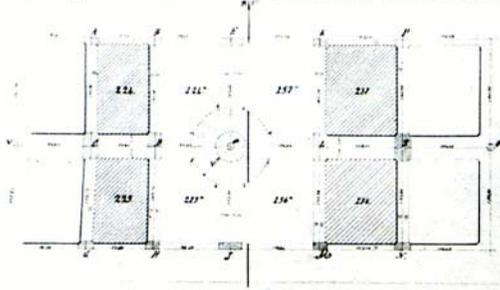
La organización espacial de Salamanca. Alternancia tiendas-viviendas en la planta baja (1869). El croquis no está a escala. Fuente: AHP, protocolo n.º 27.777.
